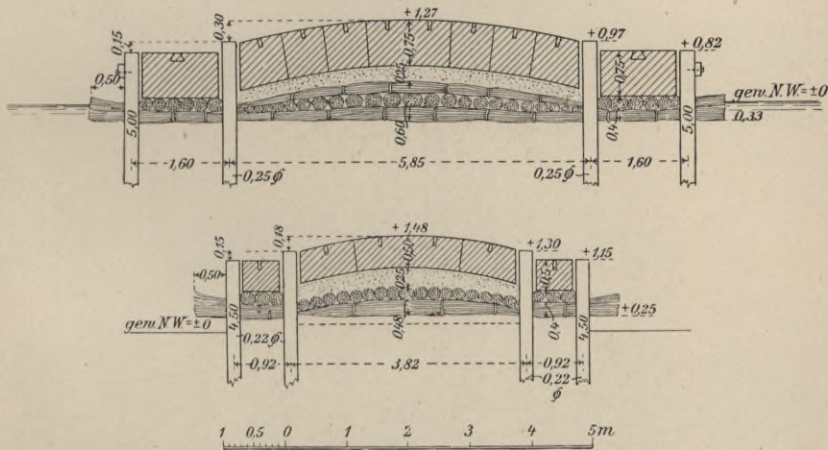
und 376. Hauptbühnen mit Abdeckung von Cementblöcken auf Sylt. 375: Querschnitt bei +35; 376: Querschnitt bei +25 des Grundrisses Abb. 374.
